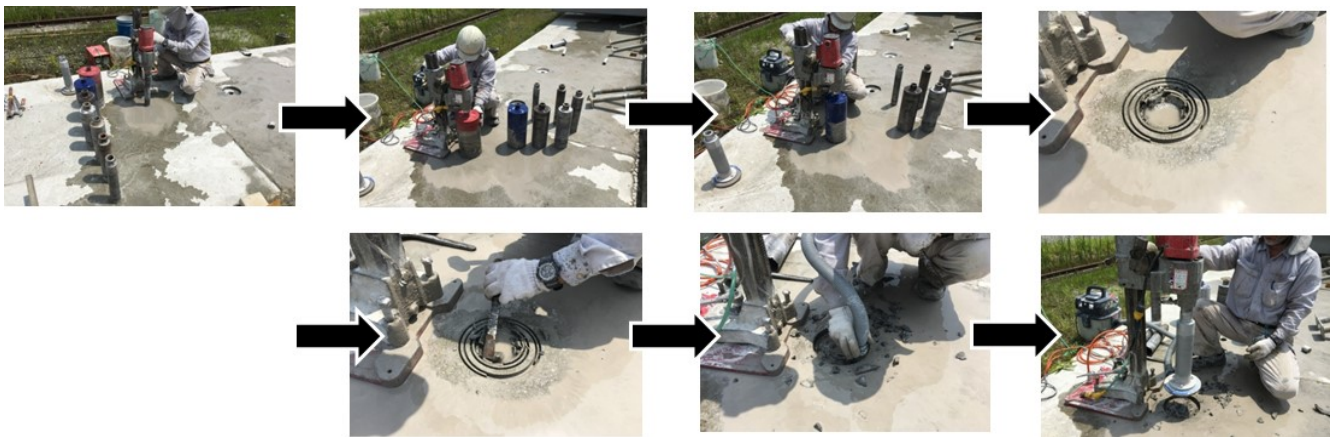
水平に研磨版を設置したコアマシンによる方法の施工状況
